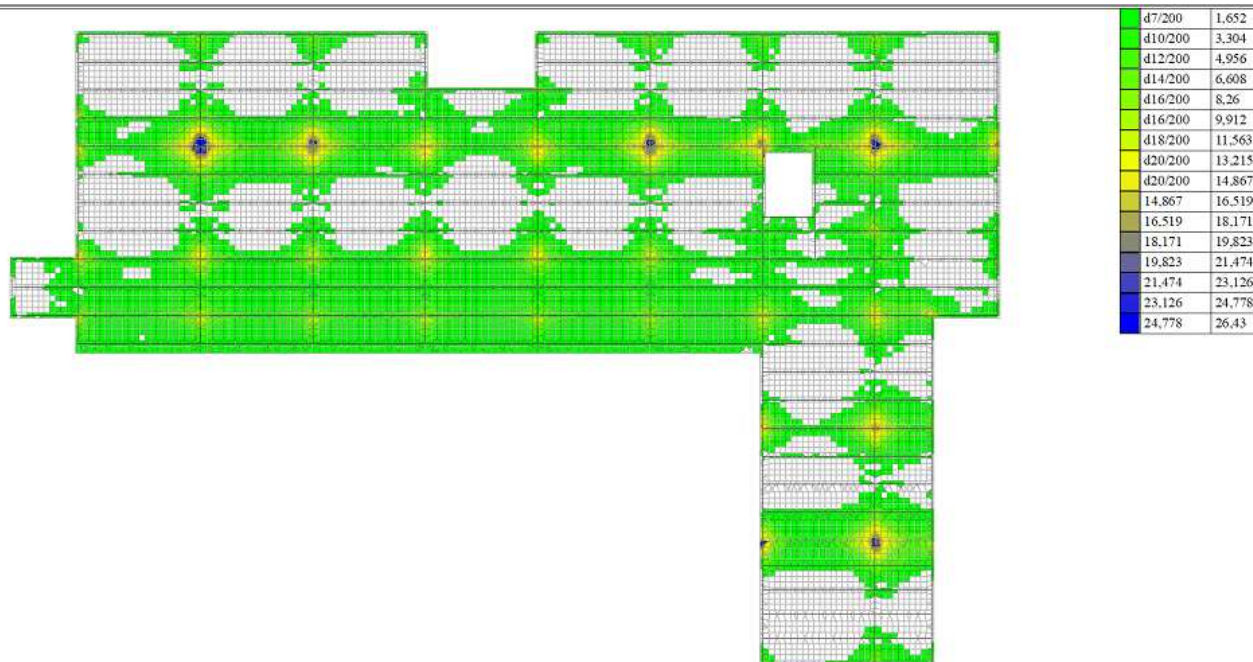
Схема верхнего армирования плиты по оси u
